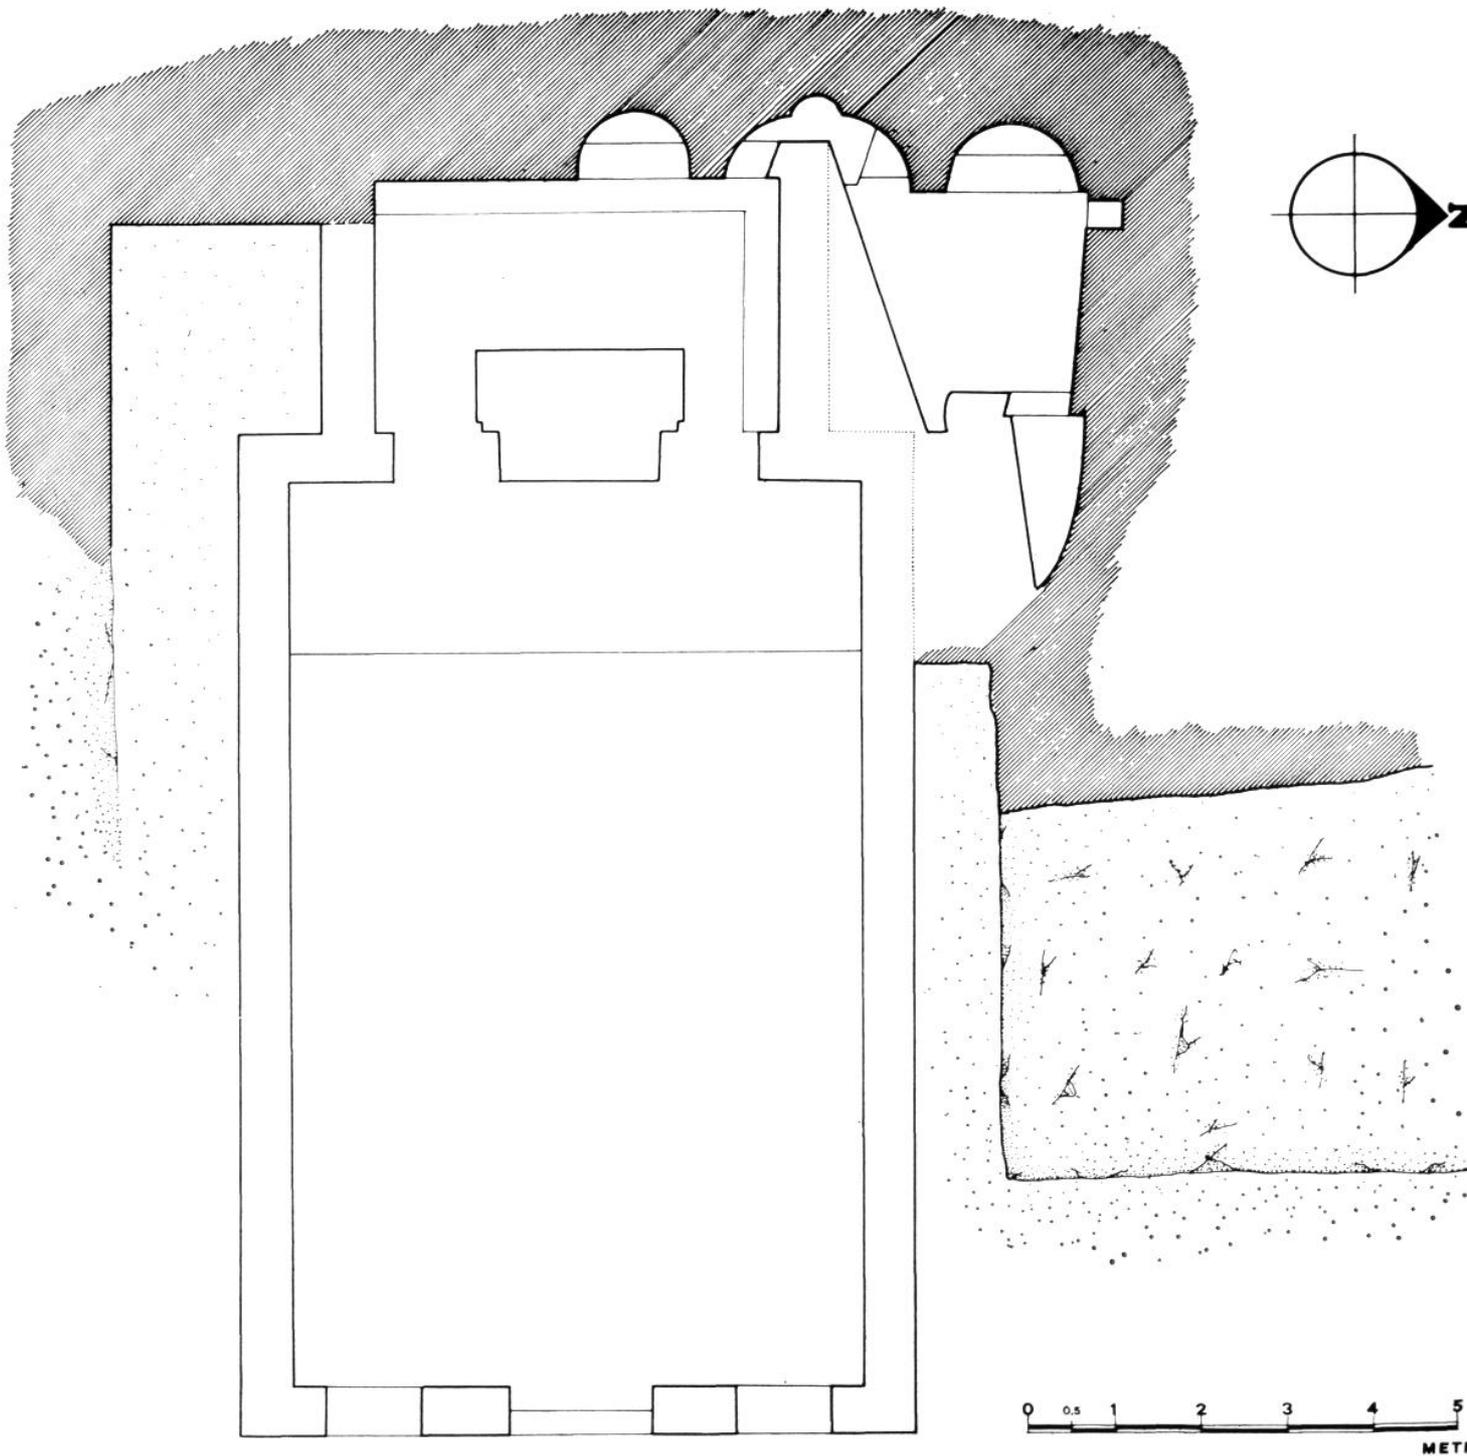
BOMARZO, COLLINA DI MONTECASOLI, CHIESA RUPESTRE, PIANTA.
